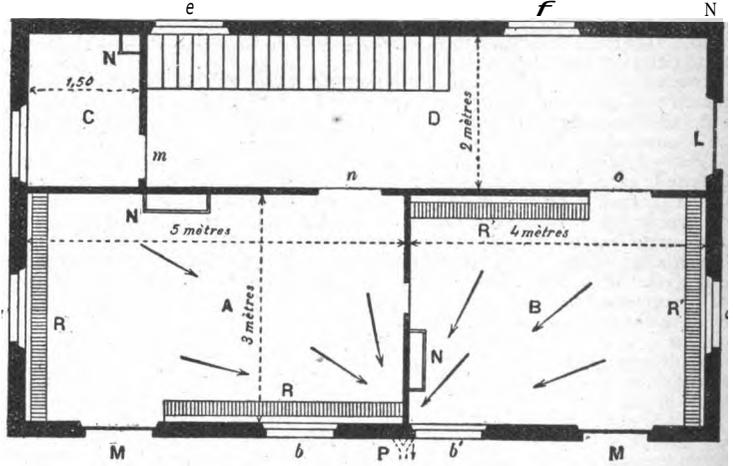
Plan d'une petite chèvrerie de rapport.
